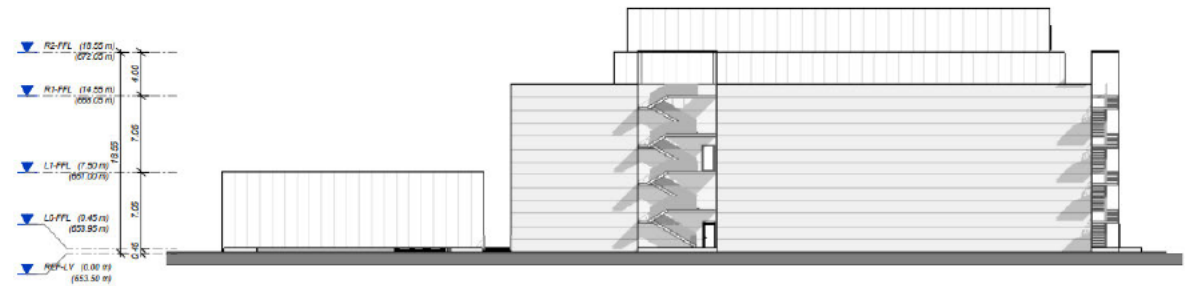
SOUTH WEST ELEVATION - Alzado Suroeste
